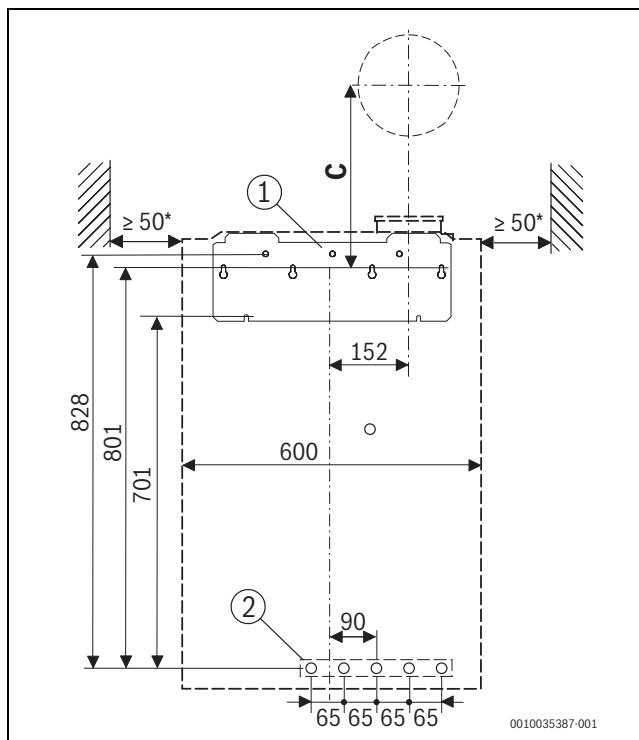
Vista frontal, conexión hidráulica horizontal (mm)
